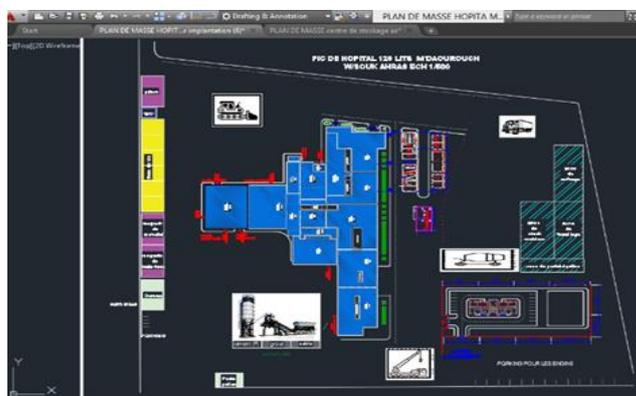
Plan d'installation de chantier du projet hospitalier de M'daourouche, (Auteur).
